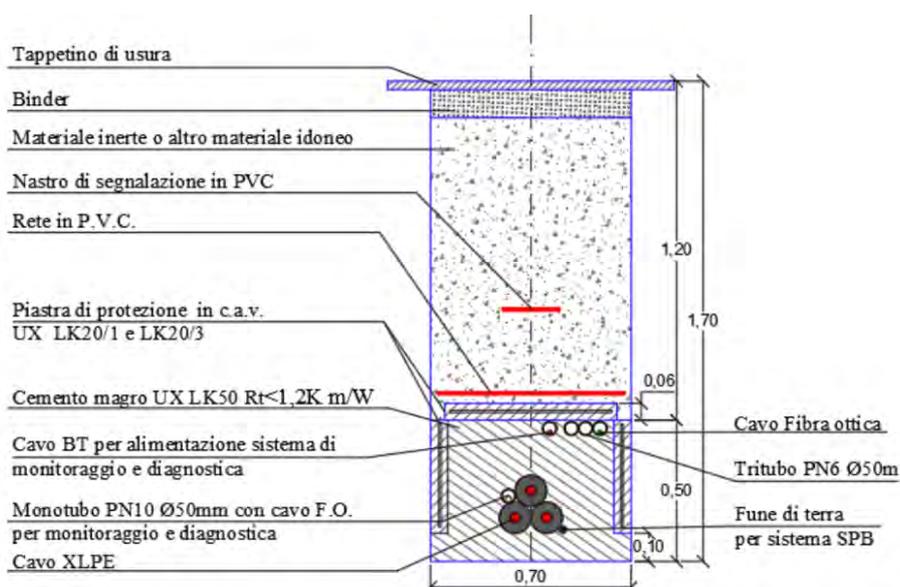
Sezione di posa cavidotto AT su Strada Asfaltata
